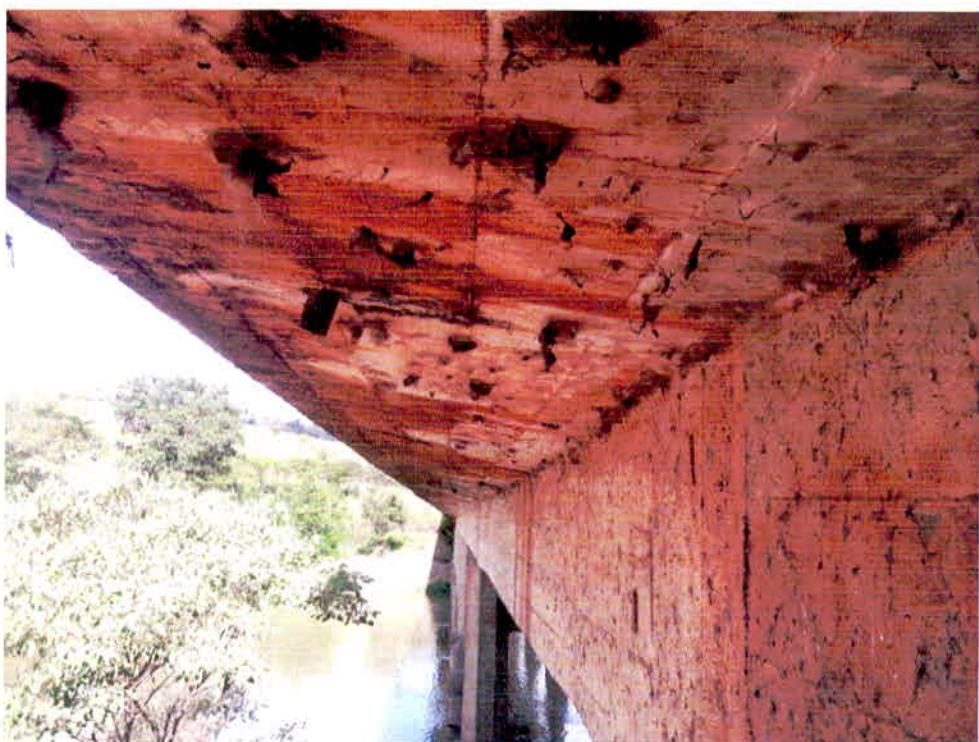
Foto 12 Vista Inferior Laje de Concreto Armado - Lixiviação e Mancha de Carbonatação / Infiltração no Concreto
